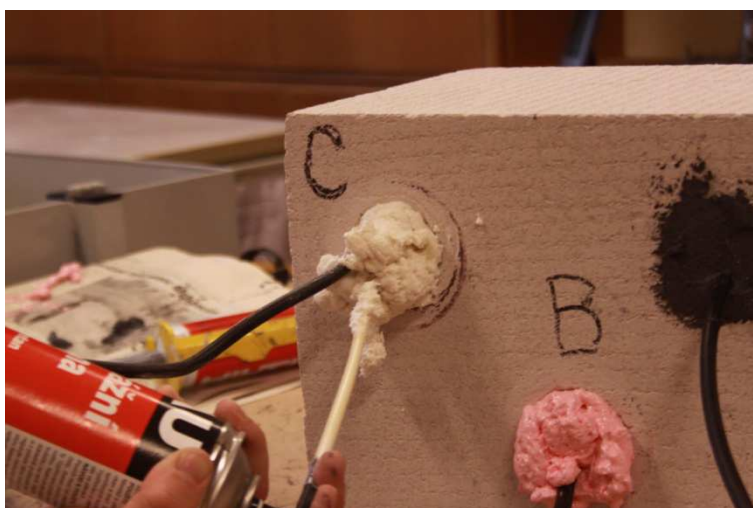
Otvor B vyplněn protipožární pěnou, otvor C vyplněn montážní pěnou [foto autora]
